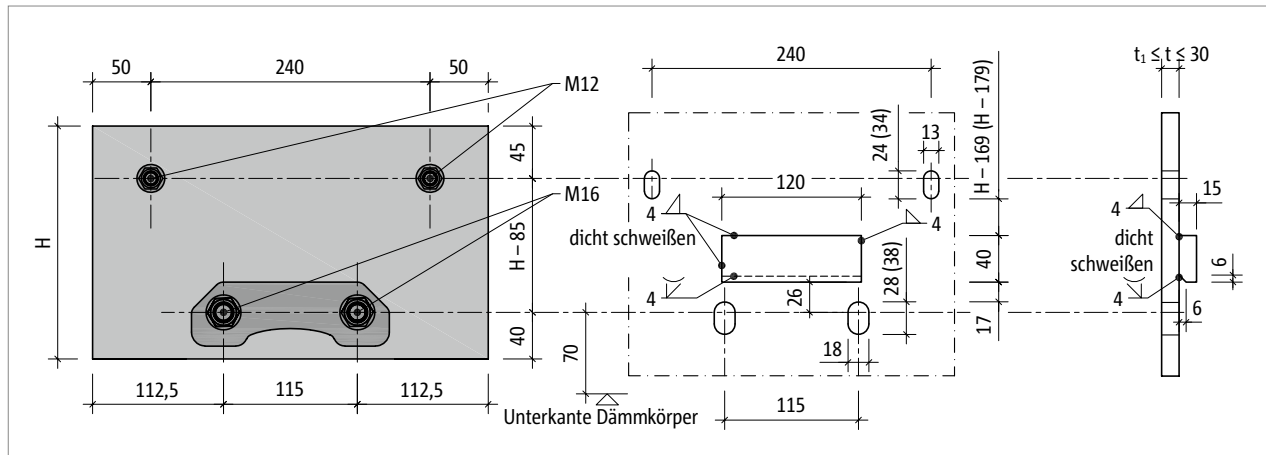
Schöck Isokorb® RT Typ SK-M1: Konstruktion des Stirnplattenanschlusses
